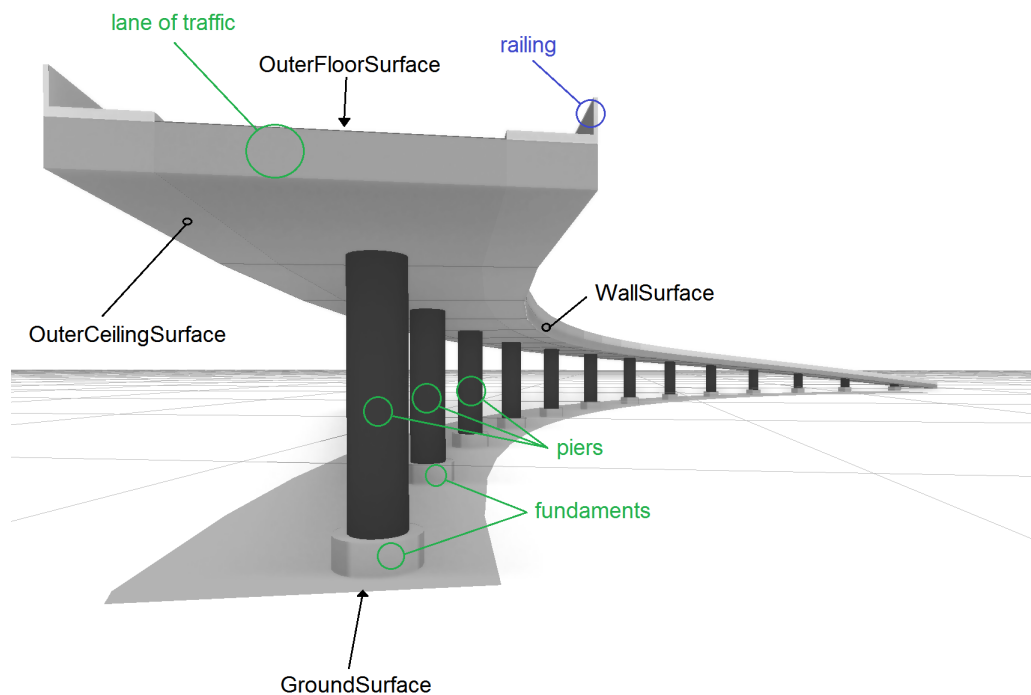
Unterteilungsmöglichkeiten einer Brücke gemäß dem CityGML-Schema (vgl. Kapitel 3.2.2): Begrenzungsflächen *_BoundarySurface* (schwarz), Konstruktionselemente *BridgeConstructionElement* (grün), Installationen *BridgeInstallation* (blau)
